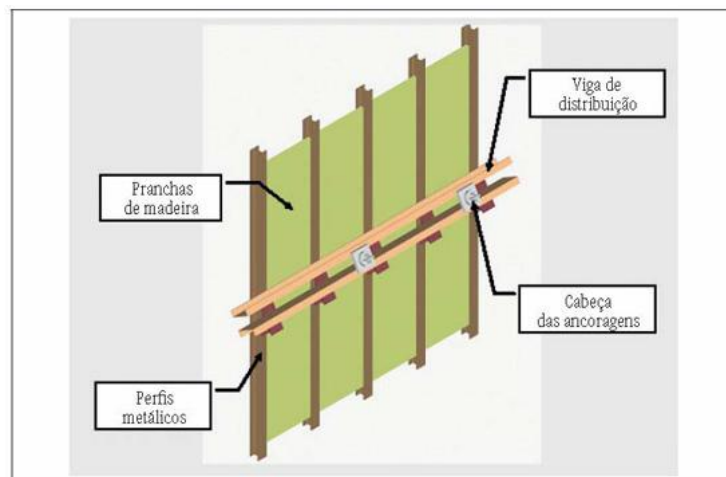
Contenção tipo Berlim provisório com ancoragens (site construironline, 2012).
